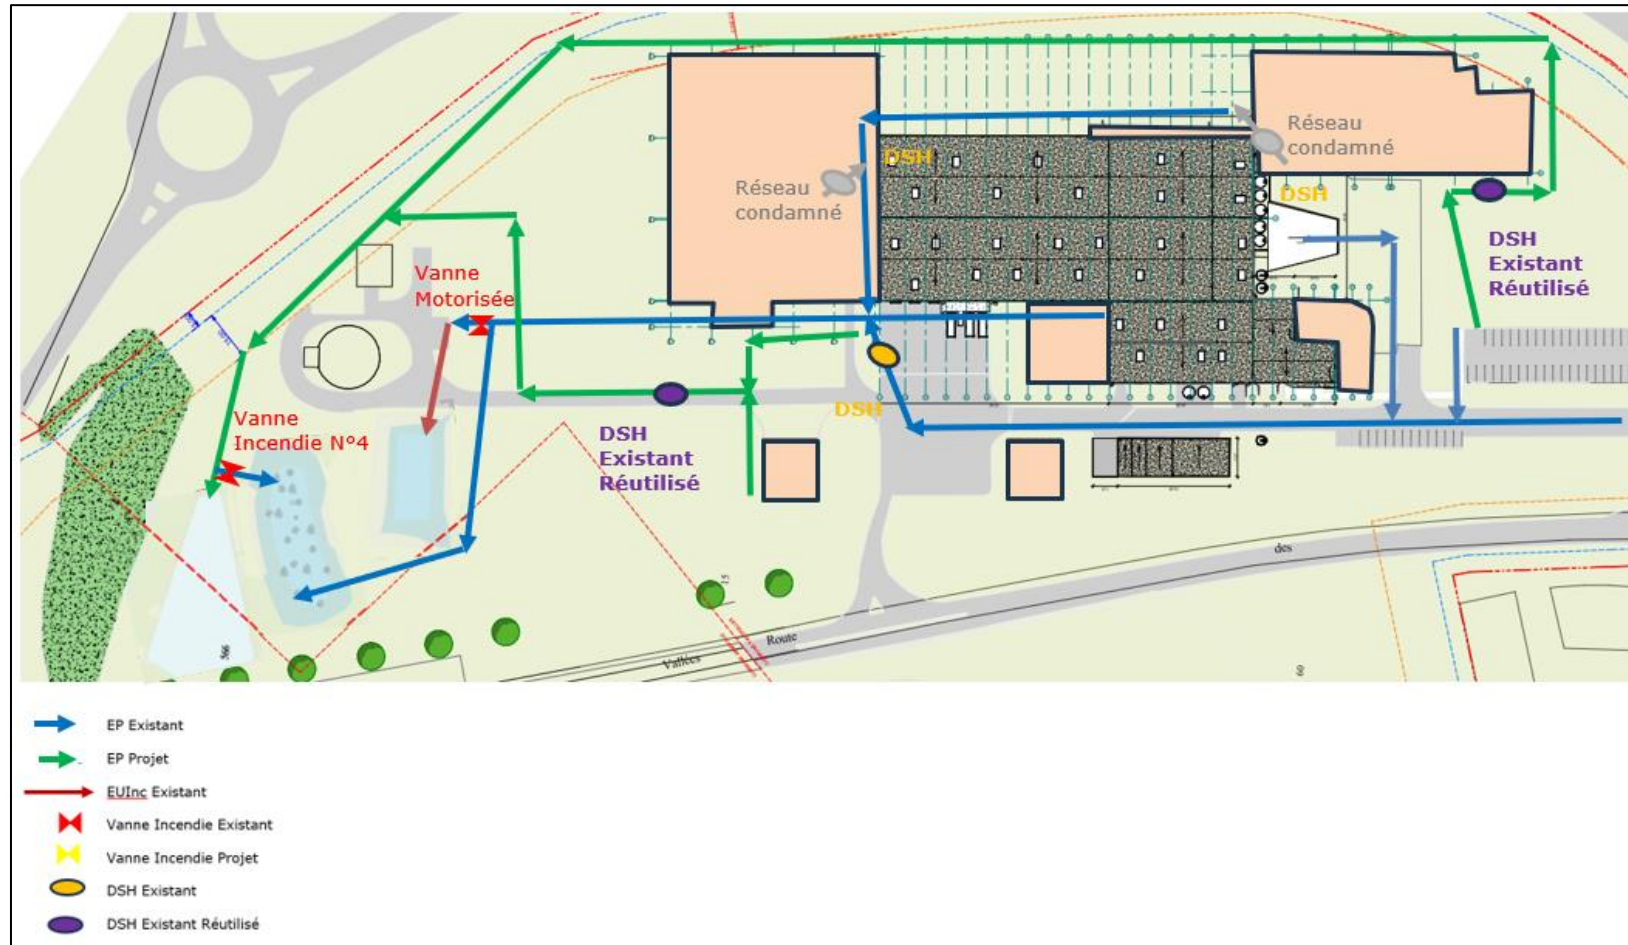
Zonage d'assainissement des eaux pluviales au niveau du site BABYDRINK projeté (Source : ELCIMAI Ingénierie)
